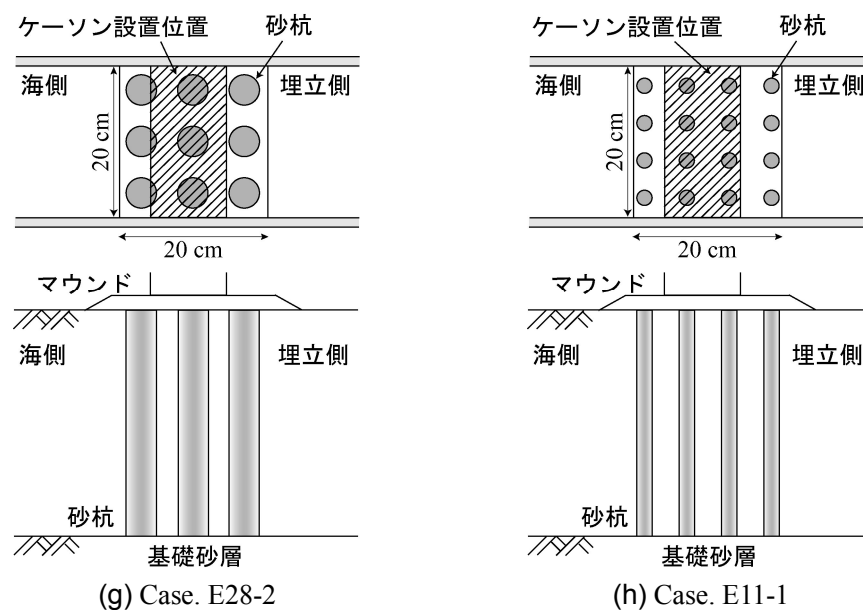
各実験ケースでの改良域の平面図と断面図（つづき）
